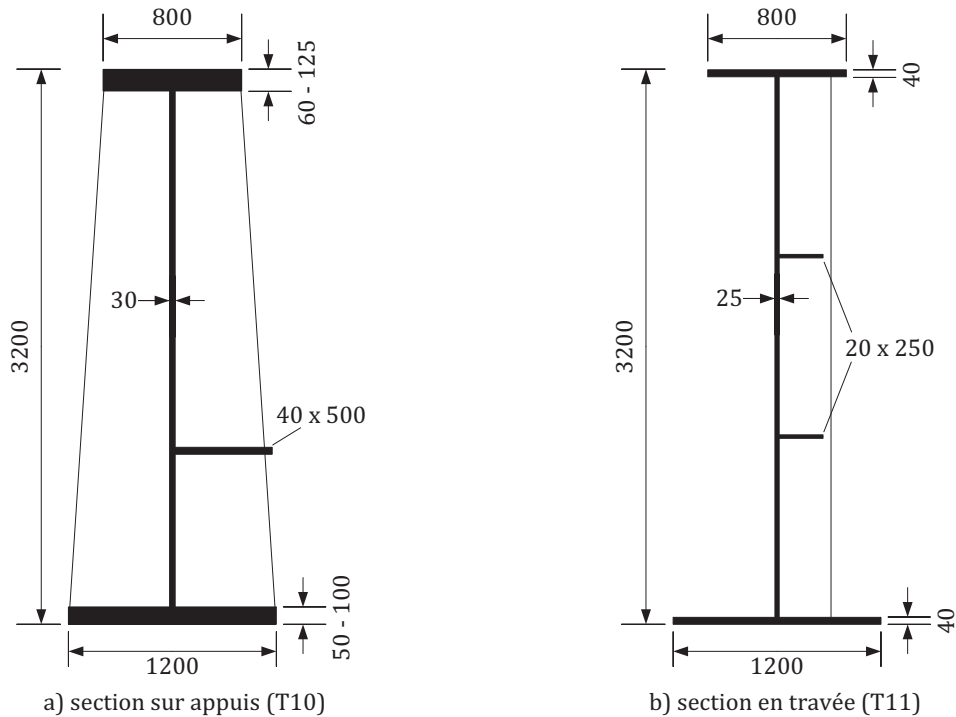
Coupes transversales et vues des deux poutres métalliques mesurées (en mm).
